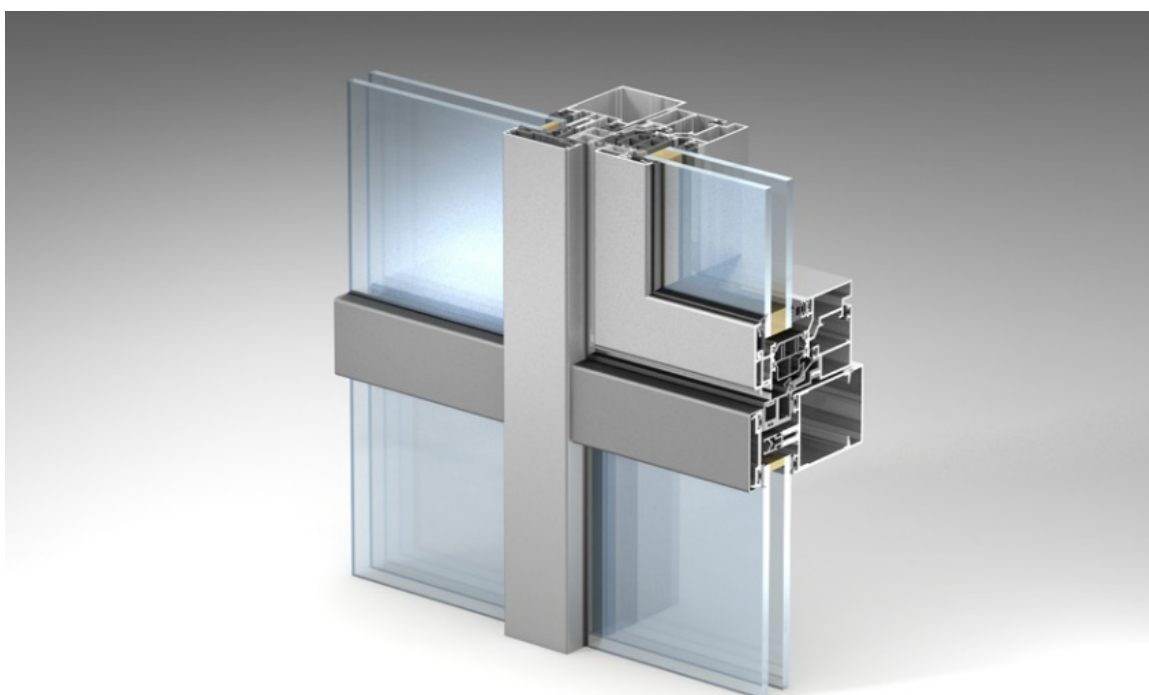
Стоечно-ригельный фасад ALT F50
